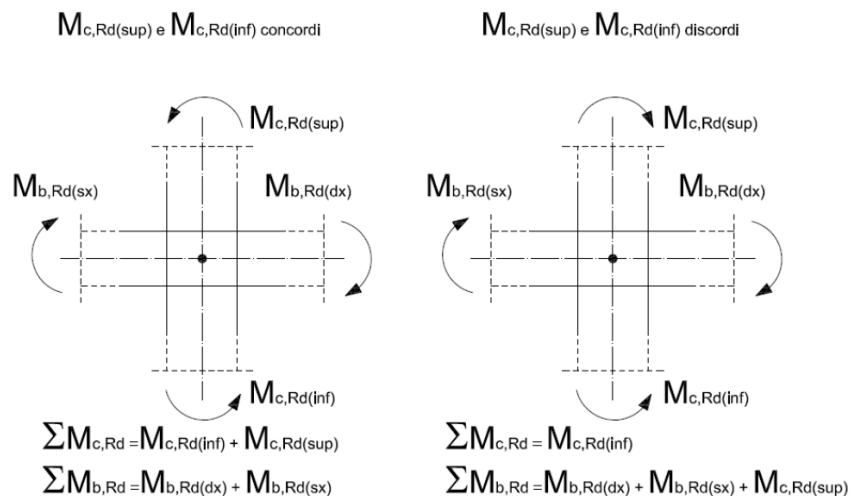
progettazione in capacità dei pilastri secondo NTC 2018
